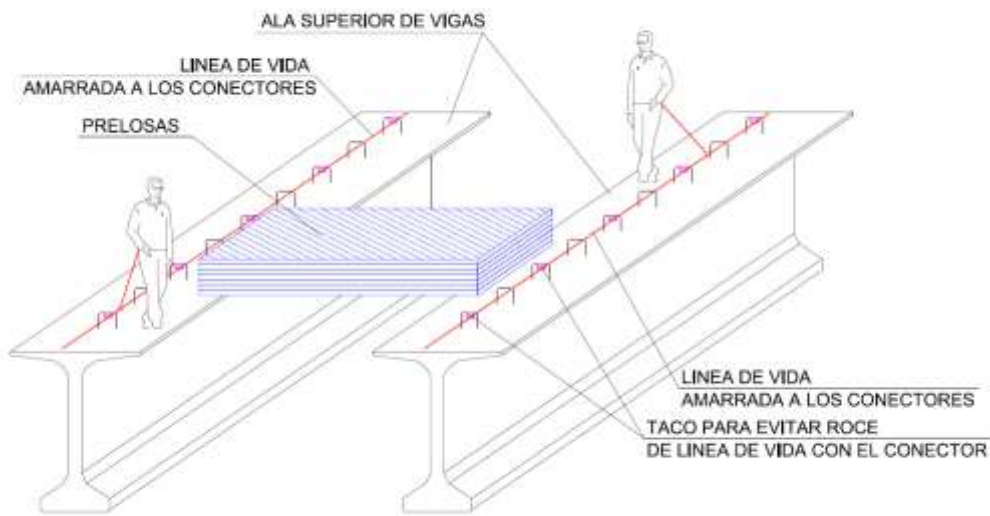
Sujeción de prelosas para su transporte a las vigas
